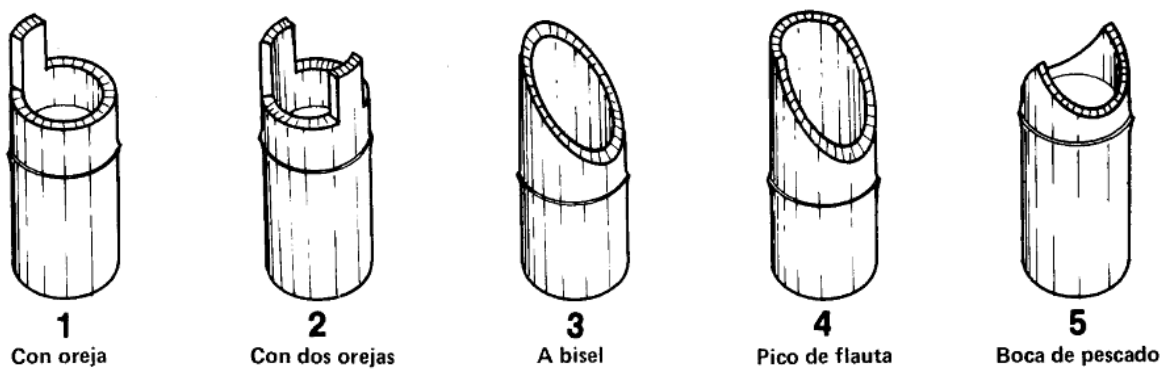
Tipos de ensambles y cortes en una estructura de Guadua
